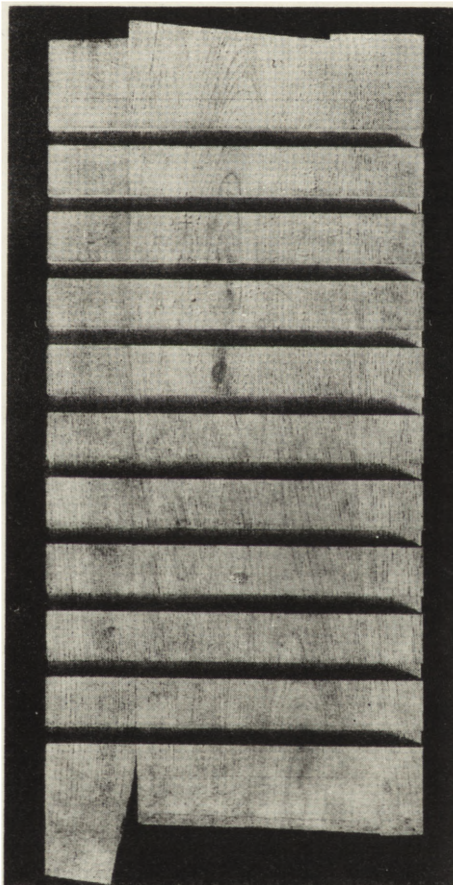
Schemat parkietu. (Fot. R. Kozłowski)
